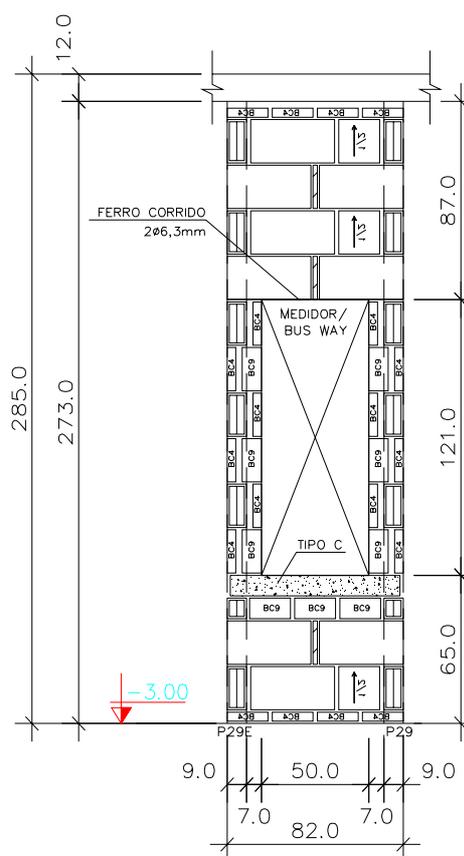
Elevação da parede do hidrante no projeto de vedação.
